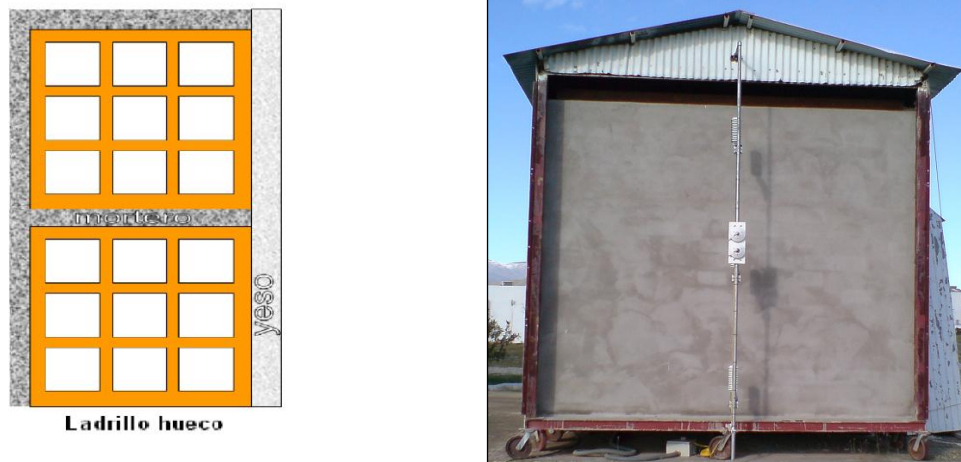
Perfil del muro base (izquierda) y vista exterior del muro (derecha)
